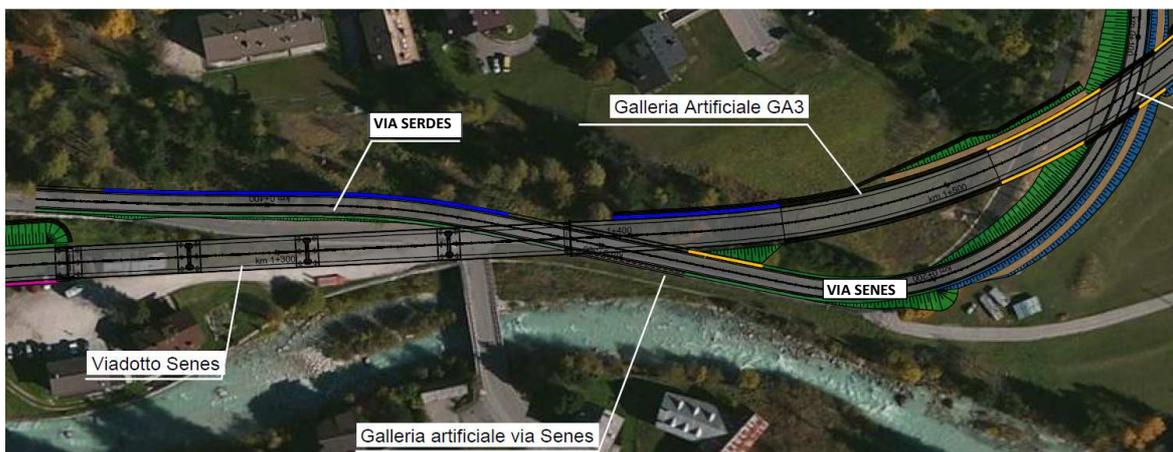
Stralcio della planimetria di progetto su fotomosaico nel tratto di Via Senes-Via Serdes
